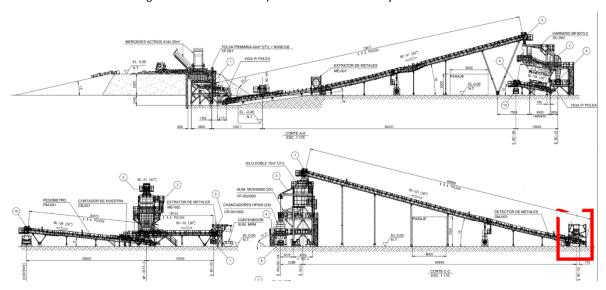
Vista transversal plano - Planta de remanejo de Pebbles LS
